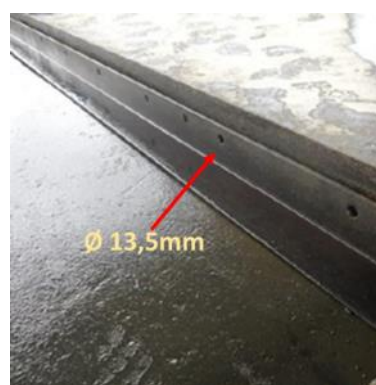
Cantoneira metálica lateral com furos de $\varnothing 13,5$ mm.
